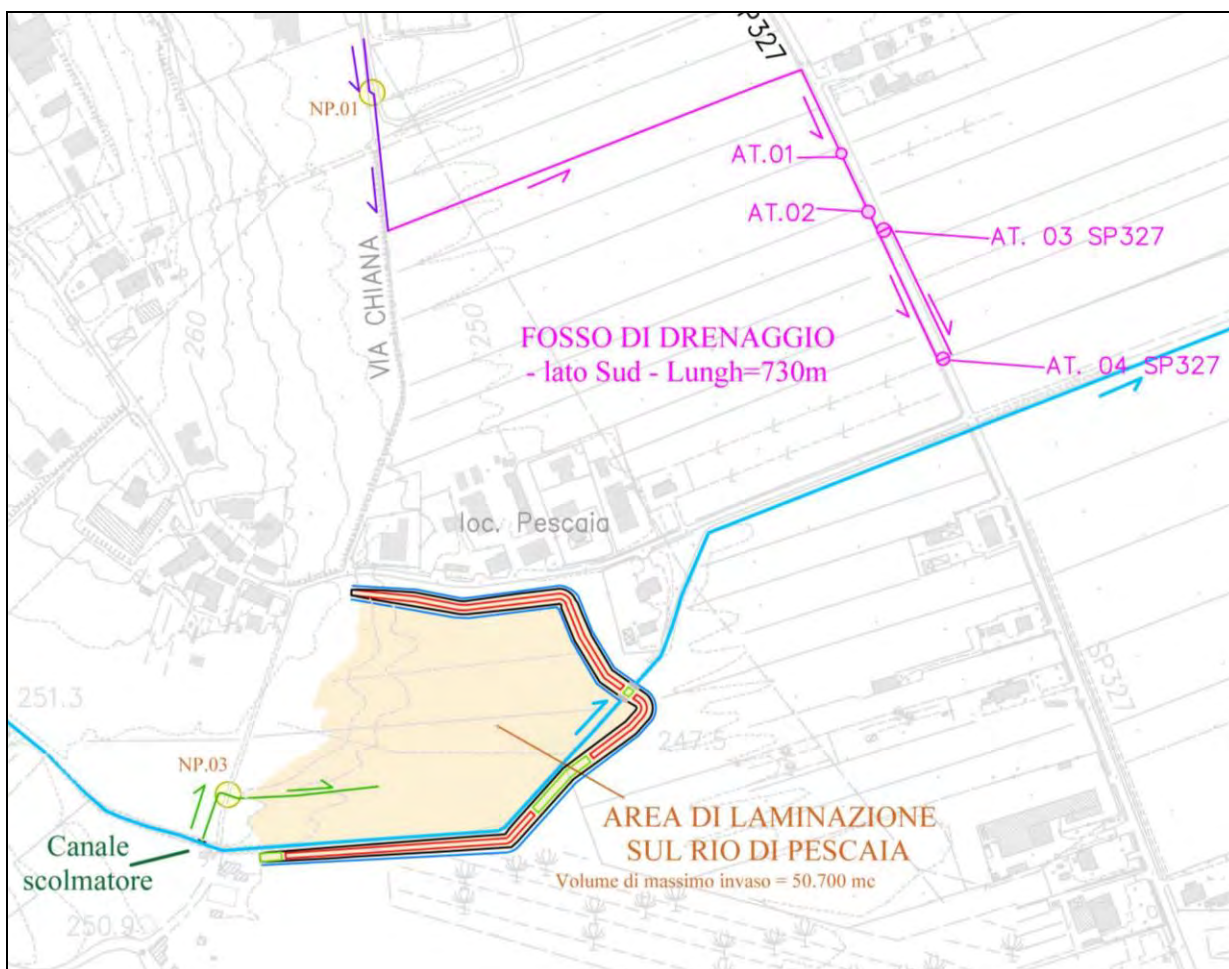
Stato di progetto: particolare planimetria generale opere su Rio Pescaia
